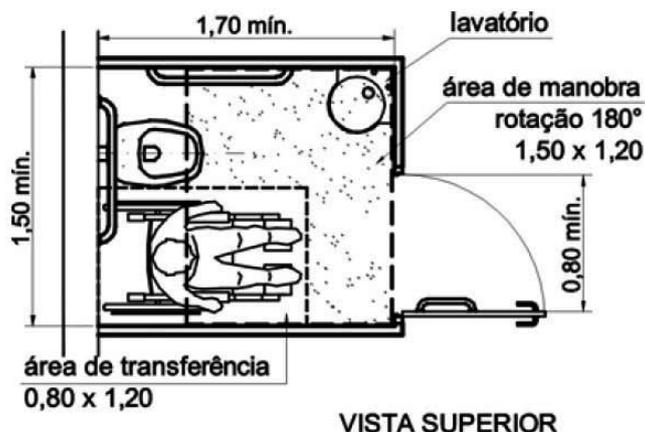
Área e espaço de manobras em Casas de banho da ABNT Brasil [7]
